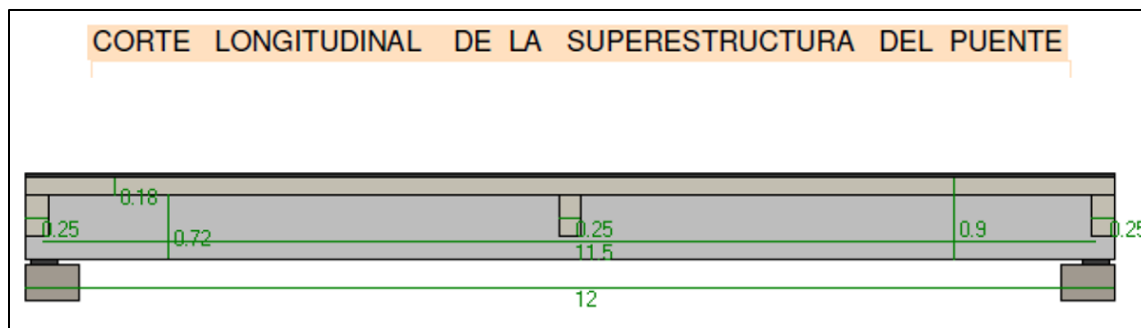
Esquema de la superestructura del puente de concreto reforzado.
